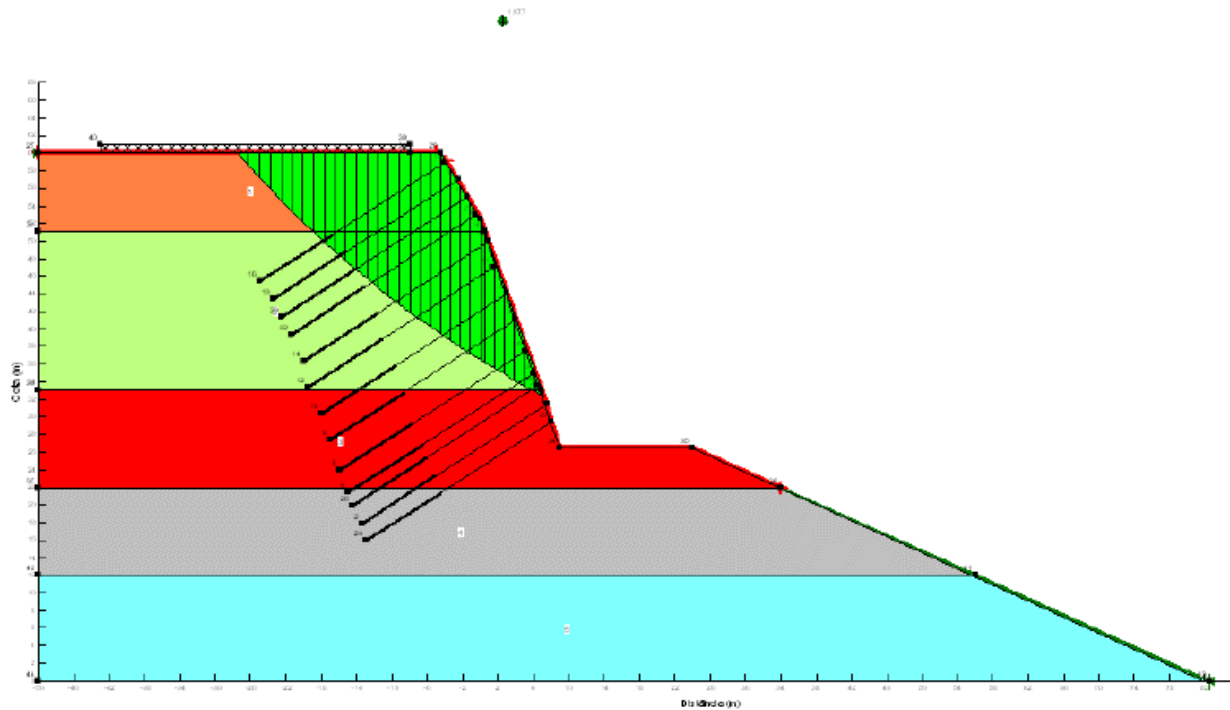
Detalhe da seção transversal de estudo, para o caso 2, mostrando-se, ainda, a solução adotada, em corte do terreno e posterior execução de cortina atirantada.
